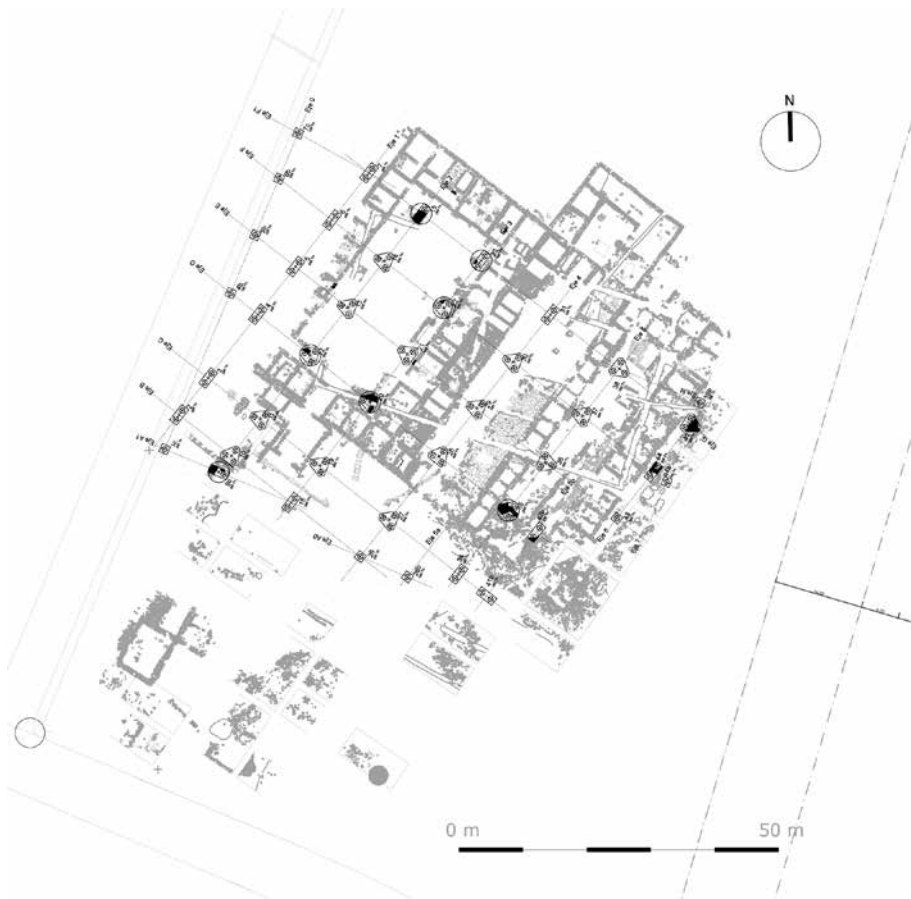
Planta de cimentación del edificio de viviendas sobre la villaromana de Castillo de la Duquesa. Castelli Arquitectos
